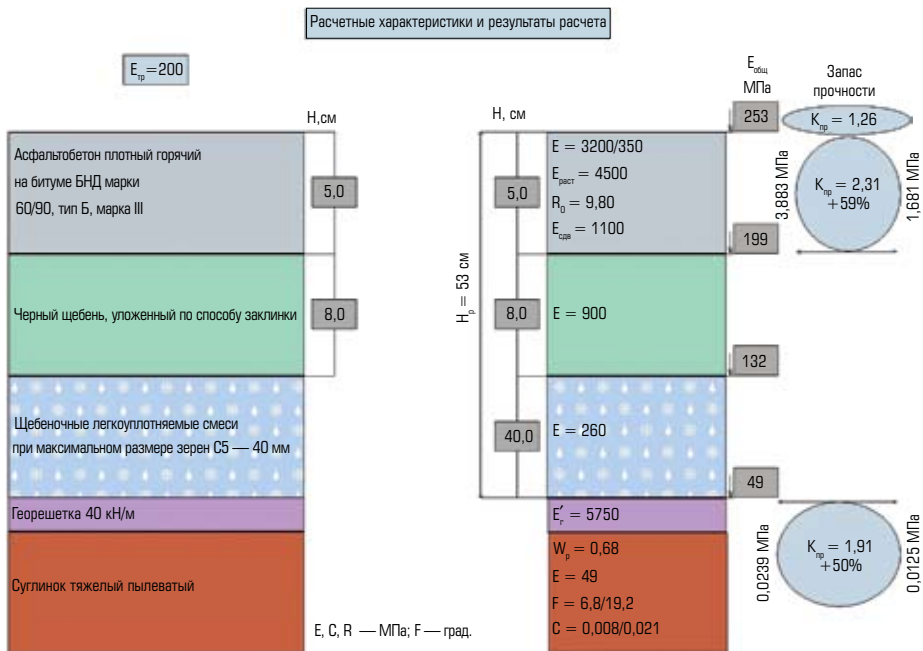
Расчет армированной конструкции дорожной одежды (георешетка 40 кН/м)
